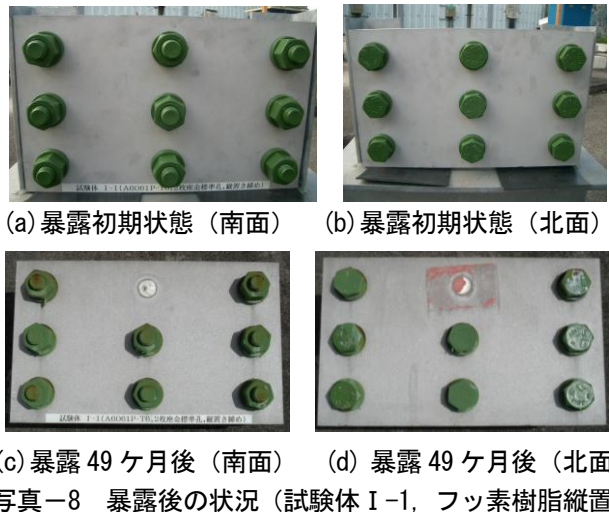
暴露後の状況 (試験体 I-1, フッ素樹脂縦置)
